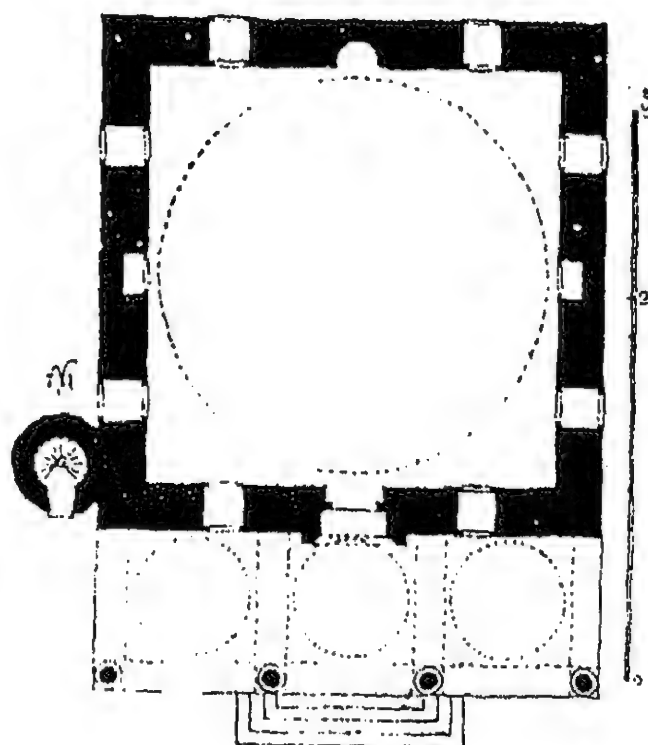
مسقط أفقي لمسجد قاسم باشا في أدرنة (عن : اصلان ابا) .
